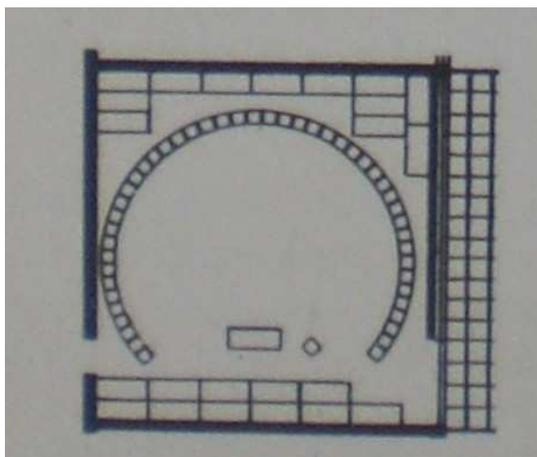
Planta baixa de uma Sala de aula com disposição em “U”.
